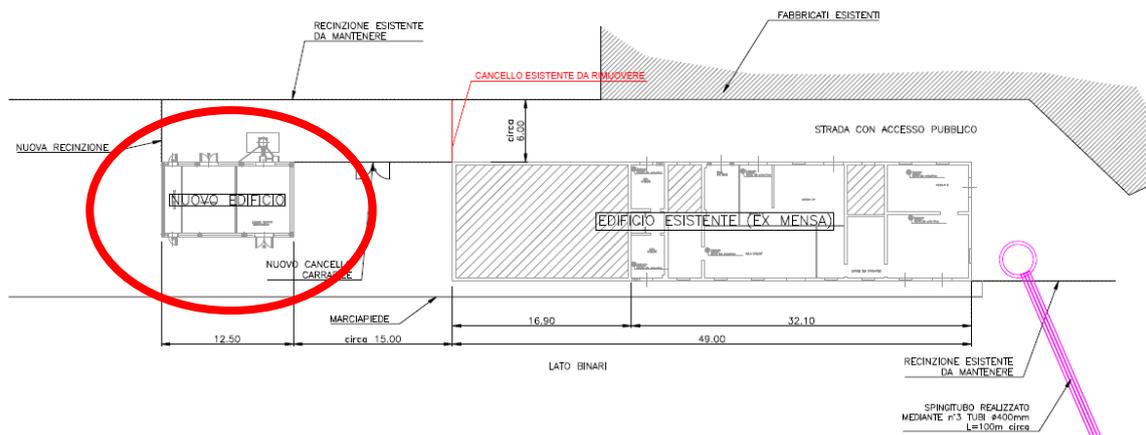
Planimetria piazzale. Cerchiato in rosso il nuovo edificio descritto nel paragrafo precedente
